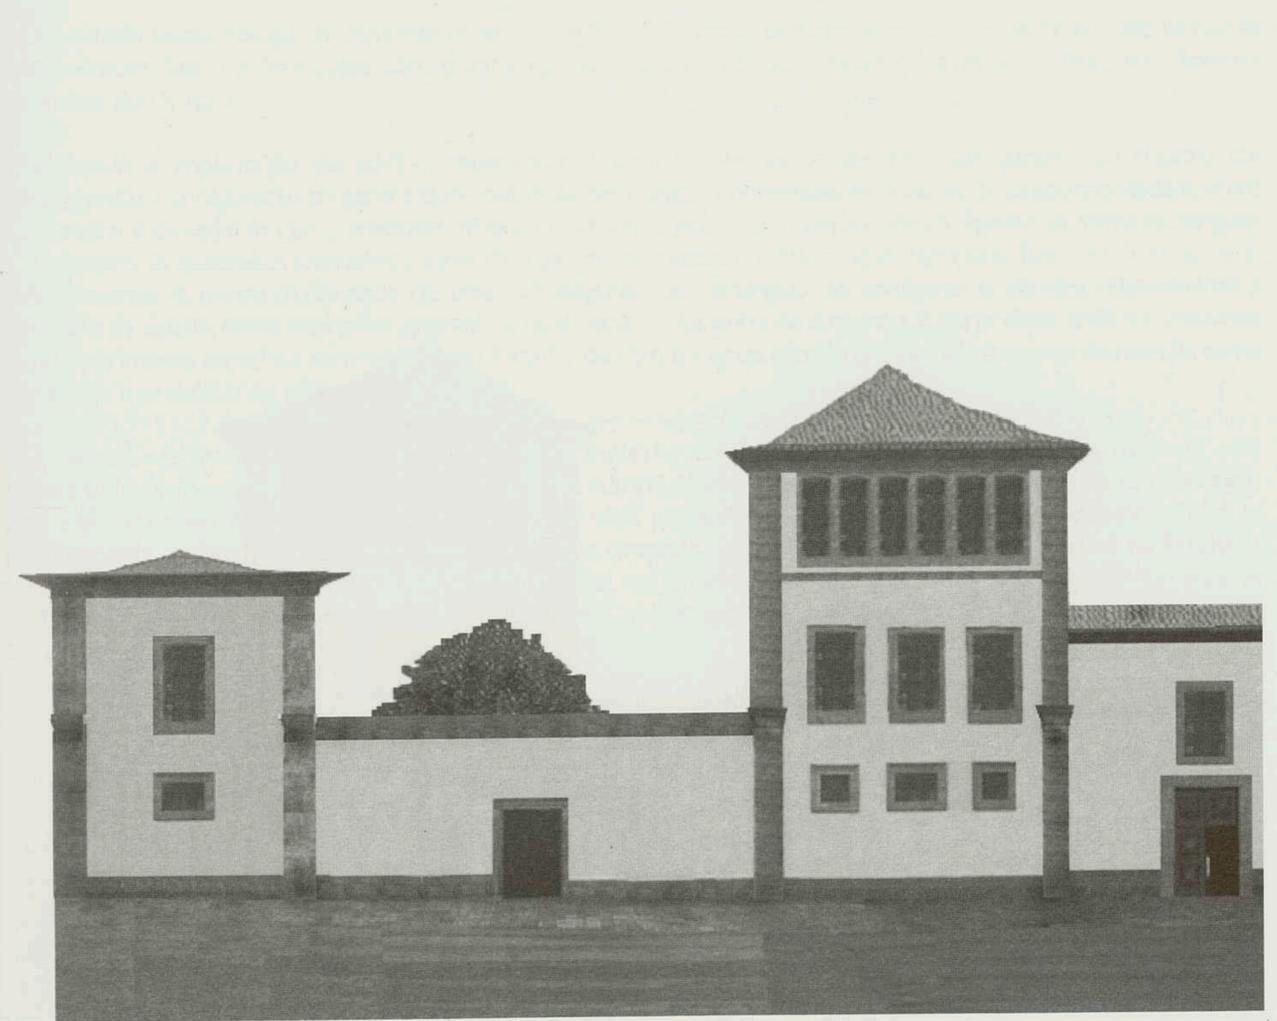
Foto- montagem. Hipótese da fachada do convento de St.^a Clara, após a construção da casa do capelão (volume mais a norte da fachada).
